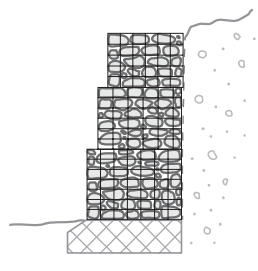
Konstruktionen doppelhäufiges Mauerwerk
